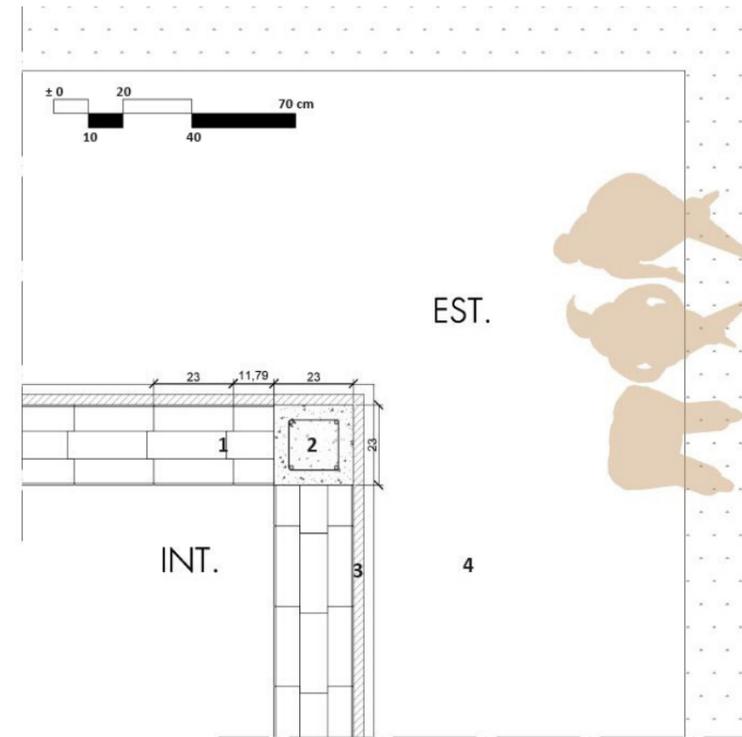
Pianta del primo corso con basamento a "panca" (Elaborazione propria).
